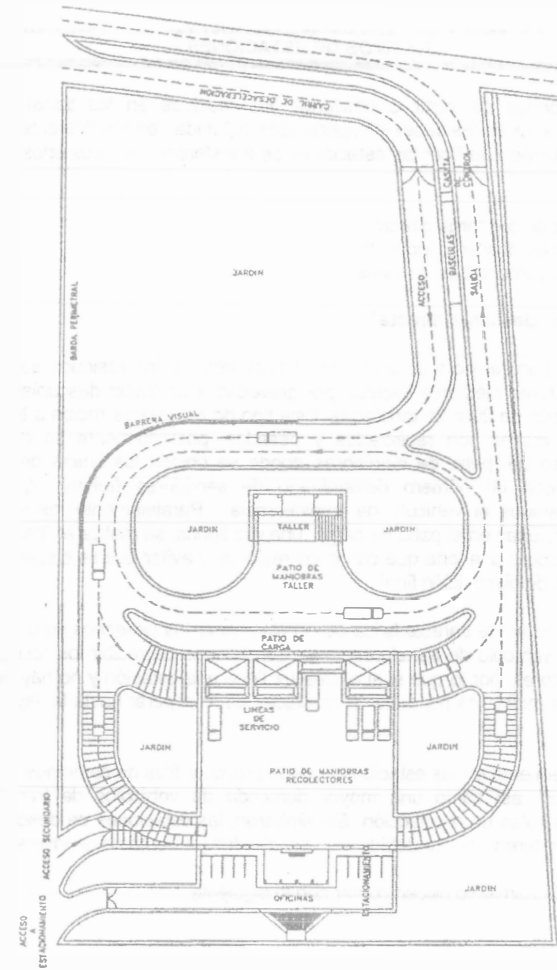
Planta de conjunto tipo de estaciones de transferencia con descarga directa (Tlalpan D.F.)
